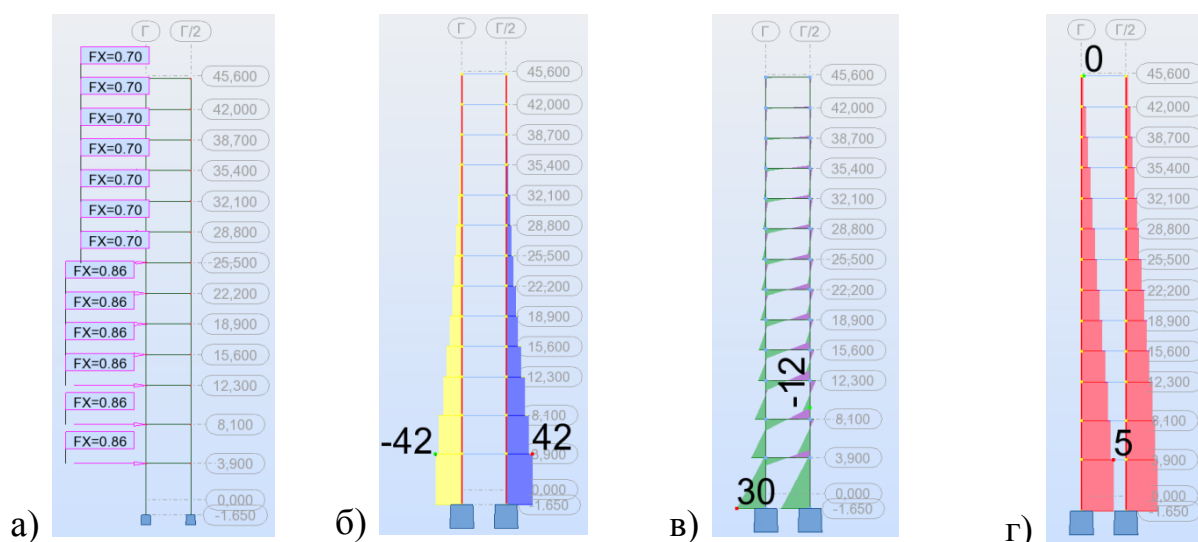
Расчет по [4]: а) расчетная схема; б) эпюра N; в) эпюра M; г) эпюра Q
